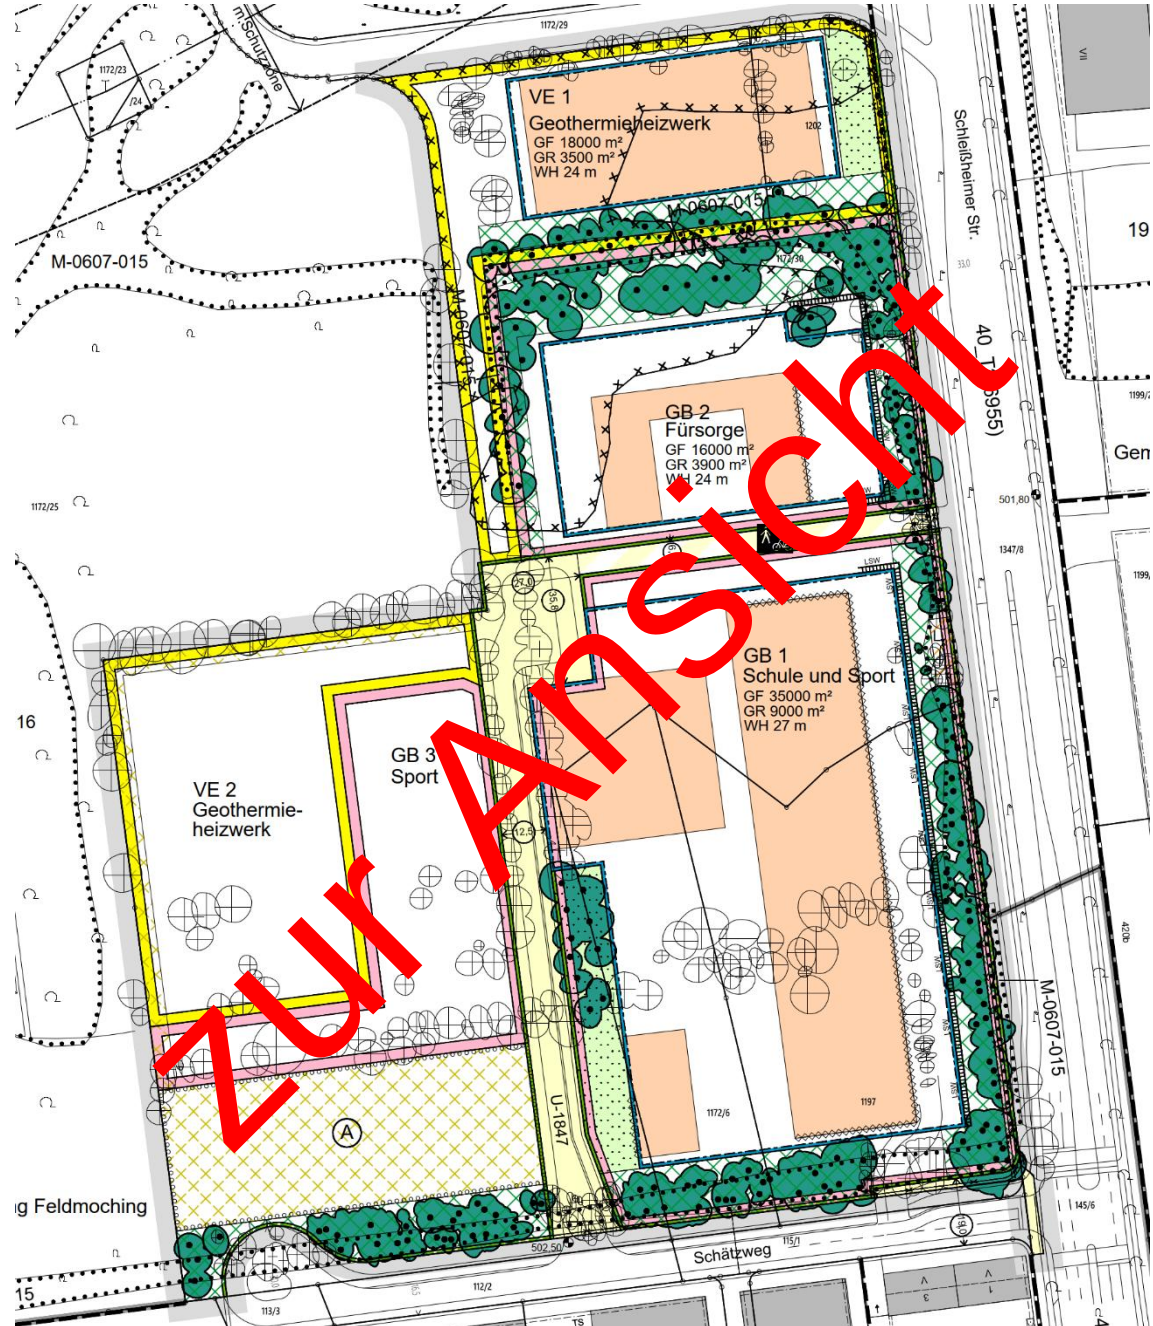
Auszug aus Bebauungsplan Nr. 1939e „Virginia-Depot“, Planstand 01/2025
